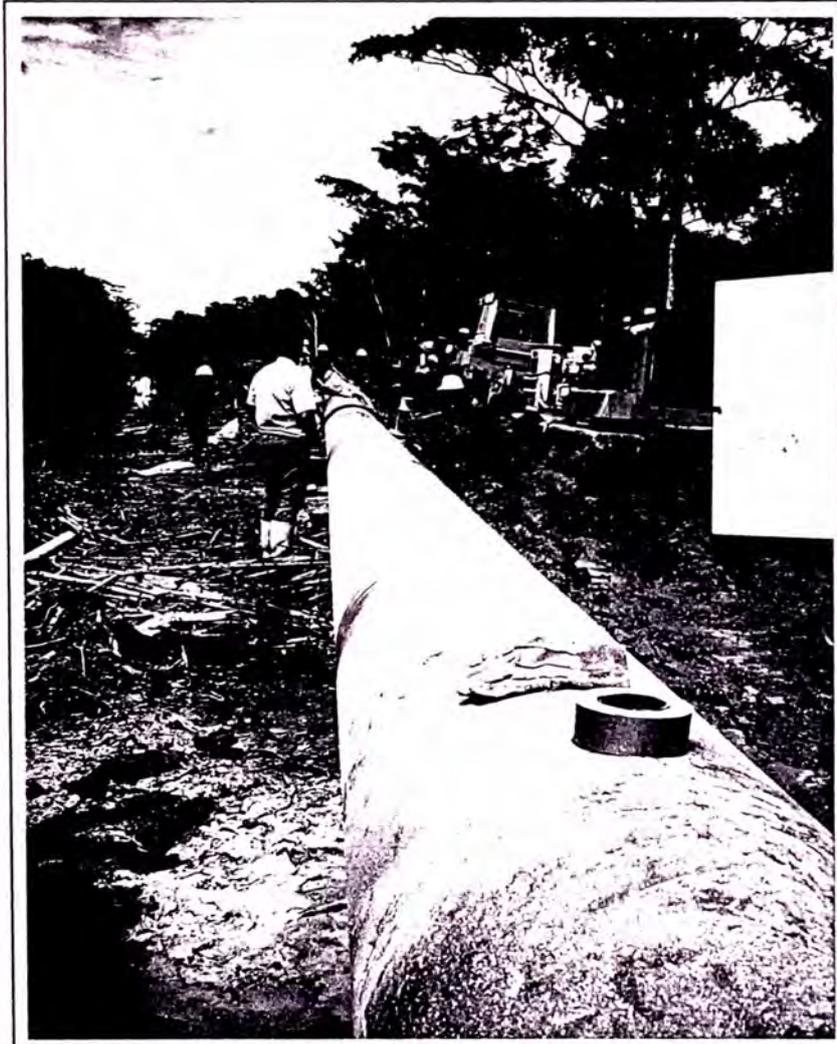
Inspección de Junta y preparación para recubrimiento epóxico.
